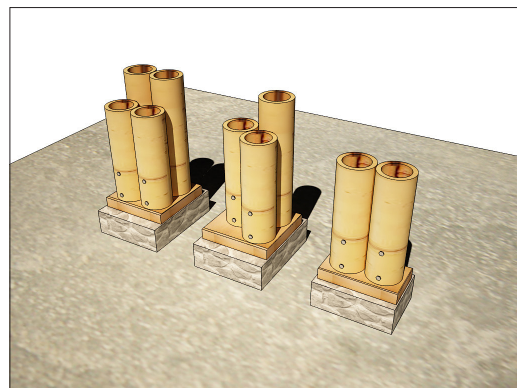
Posibilidades de estructuración de columnas (Autoría propia, 2015).
